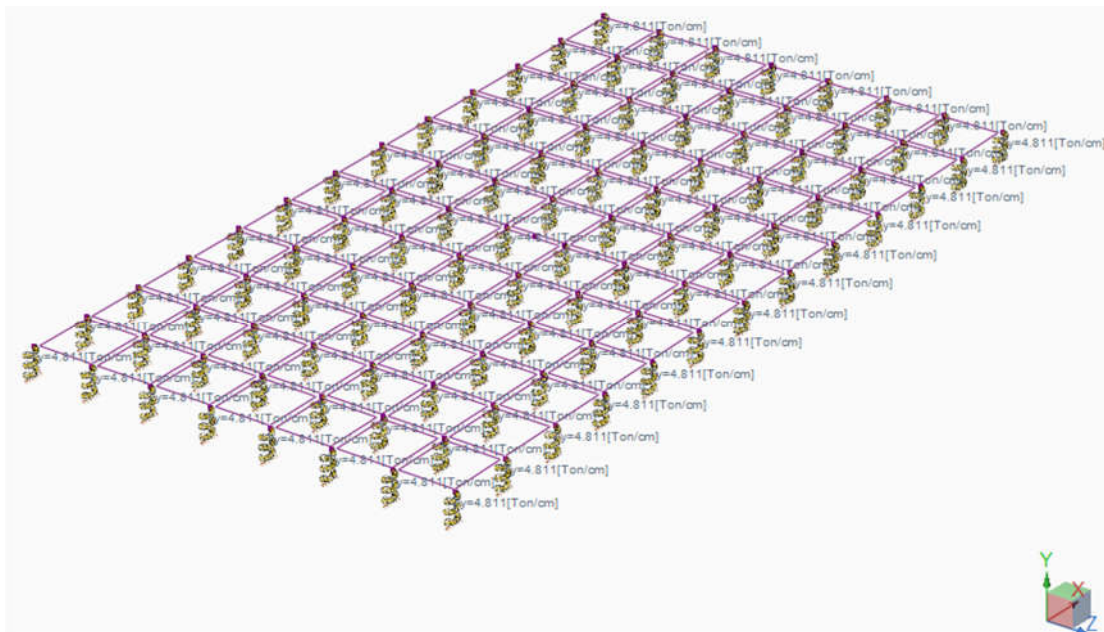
Losa de Fundación Idealizada en Ram Element
